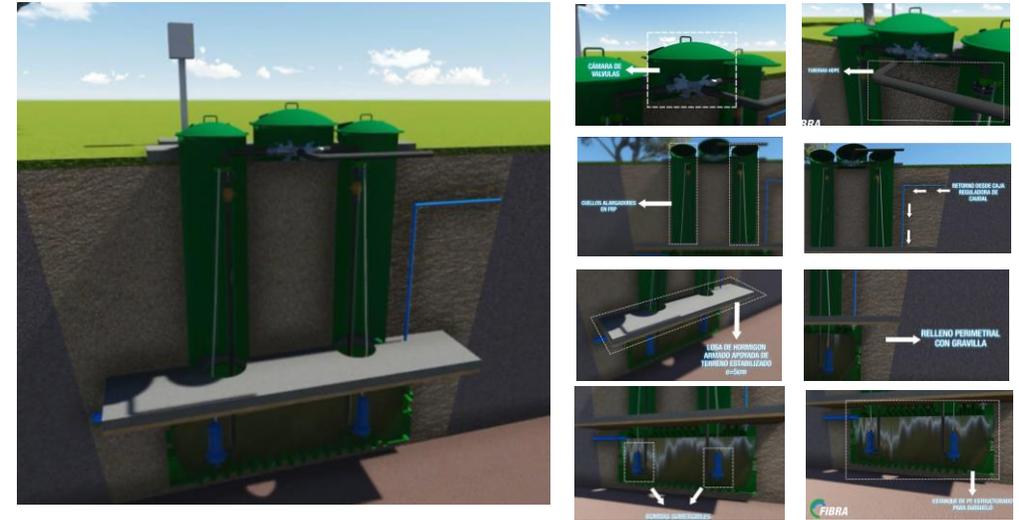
Tipo de planta elevadora de aguas servidas empresa Fibra.
